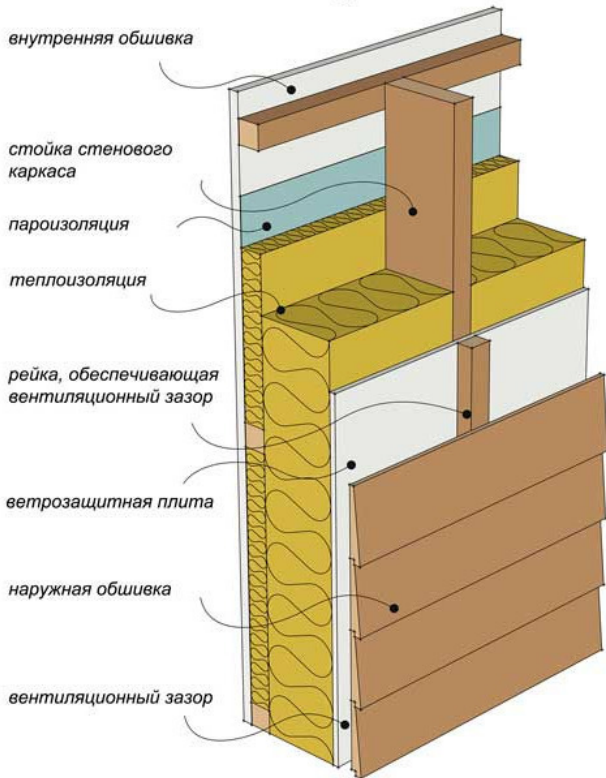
Легкая наружная стена из деревянного каркаса с горизонтальной наружной обшивкой из вагонки
